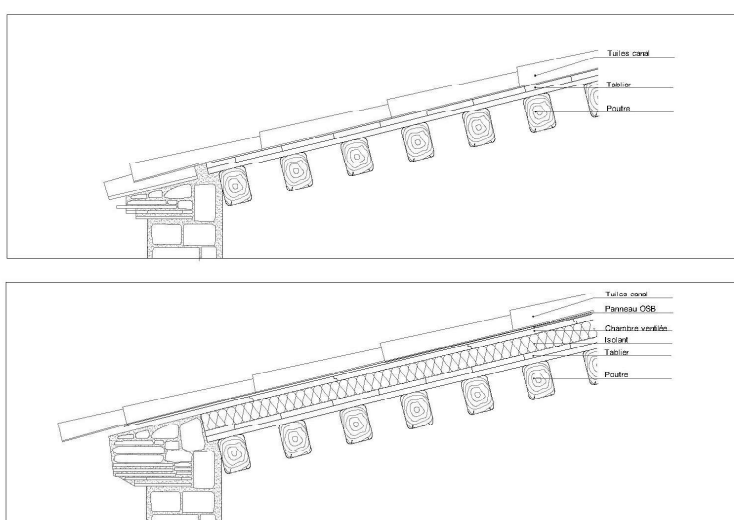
Action de retrofit sur la toiture. État existant (en haut) et intervention avec couche isolante et barrière radiative (en bas)
